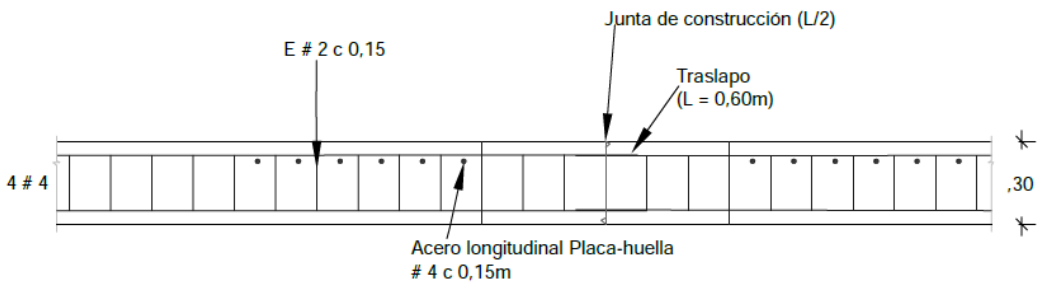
Junta transversal de construcción de la riostra (corte longitudinal).
